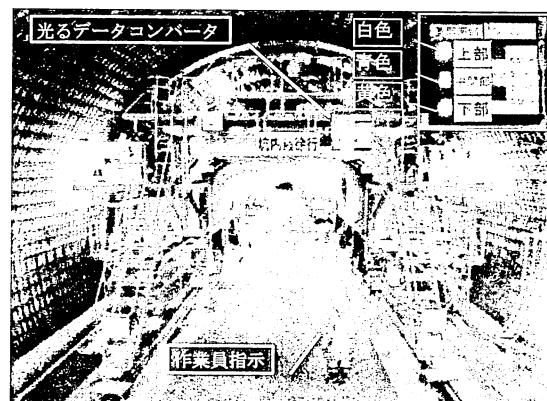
中流动覆工コンクリート圧力管理状況⁷⁾
